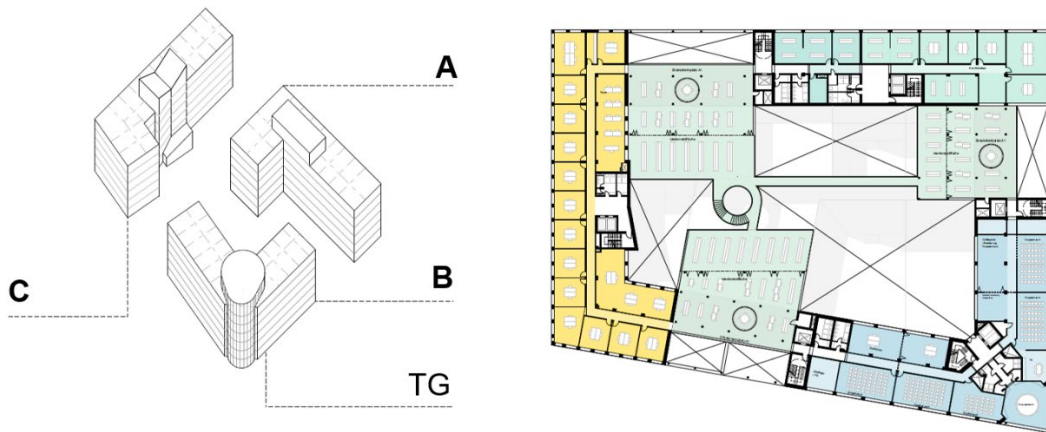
Machbarkeitsstudie: Isometrie des Bestandskomplexes aus drei Bürogebäuden (links), Grundriss 1. OG Learning Center mit baulichen Ergänzungen und Innenhof (rechts)
